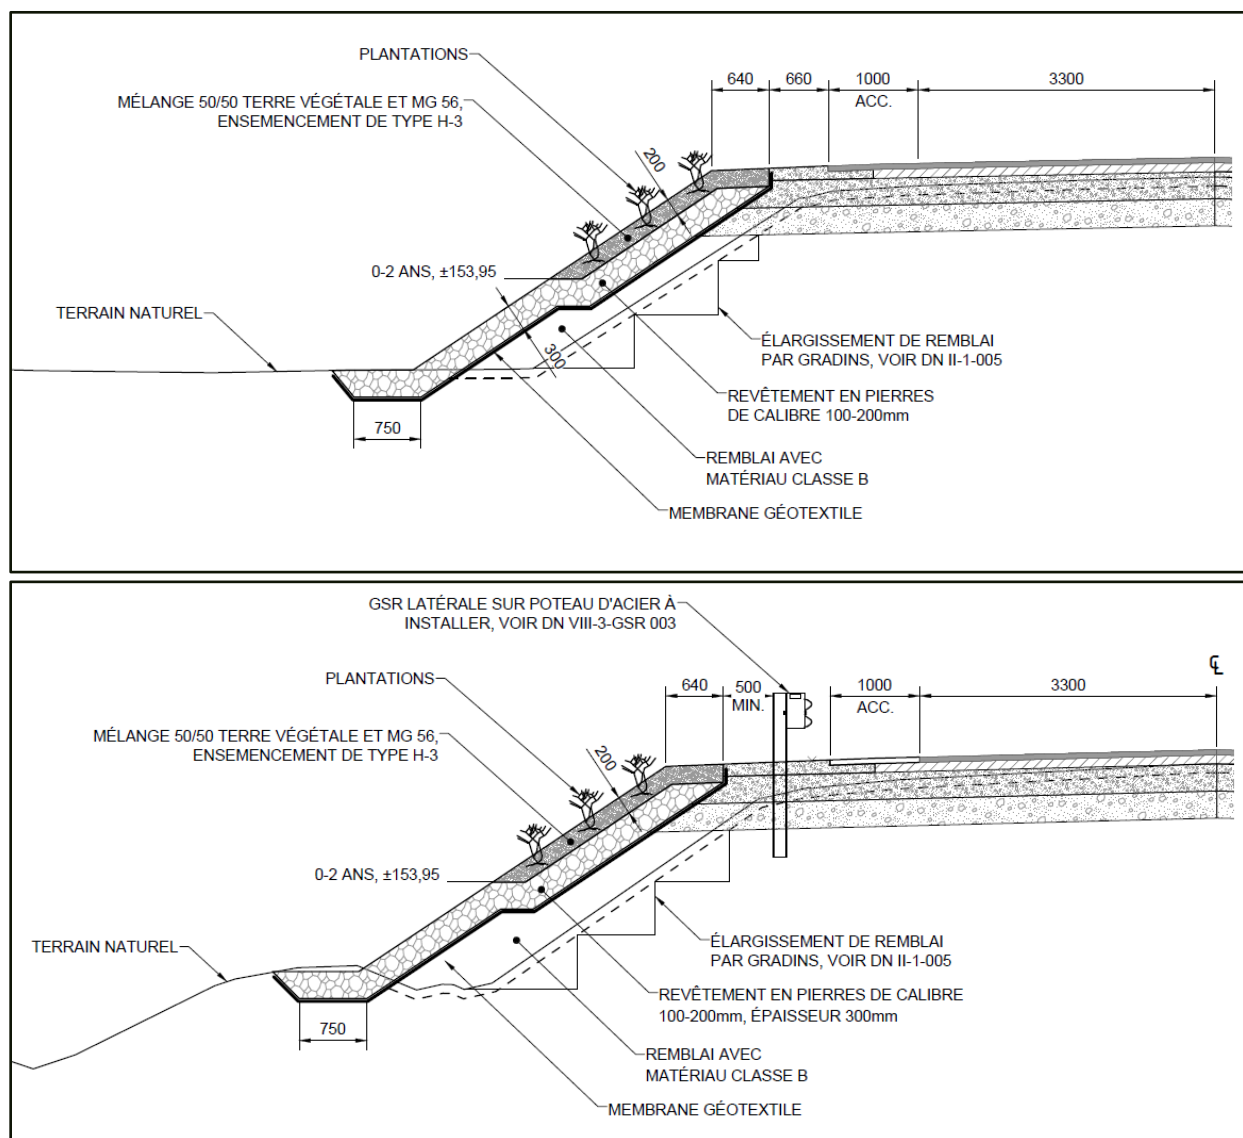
Coupe type de revêtement de protection en pierres et végétation
